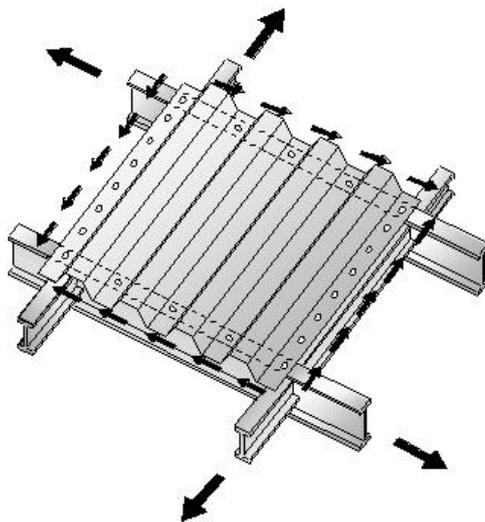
Schubfeld zur Sicherung der Gesamtstabilität
